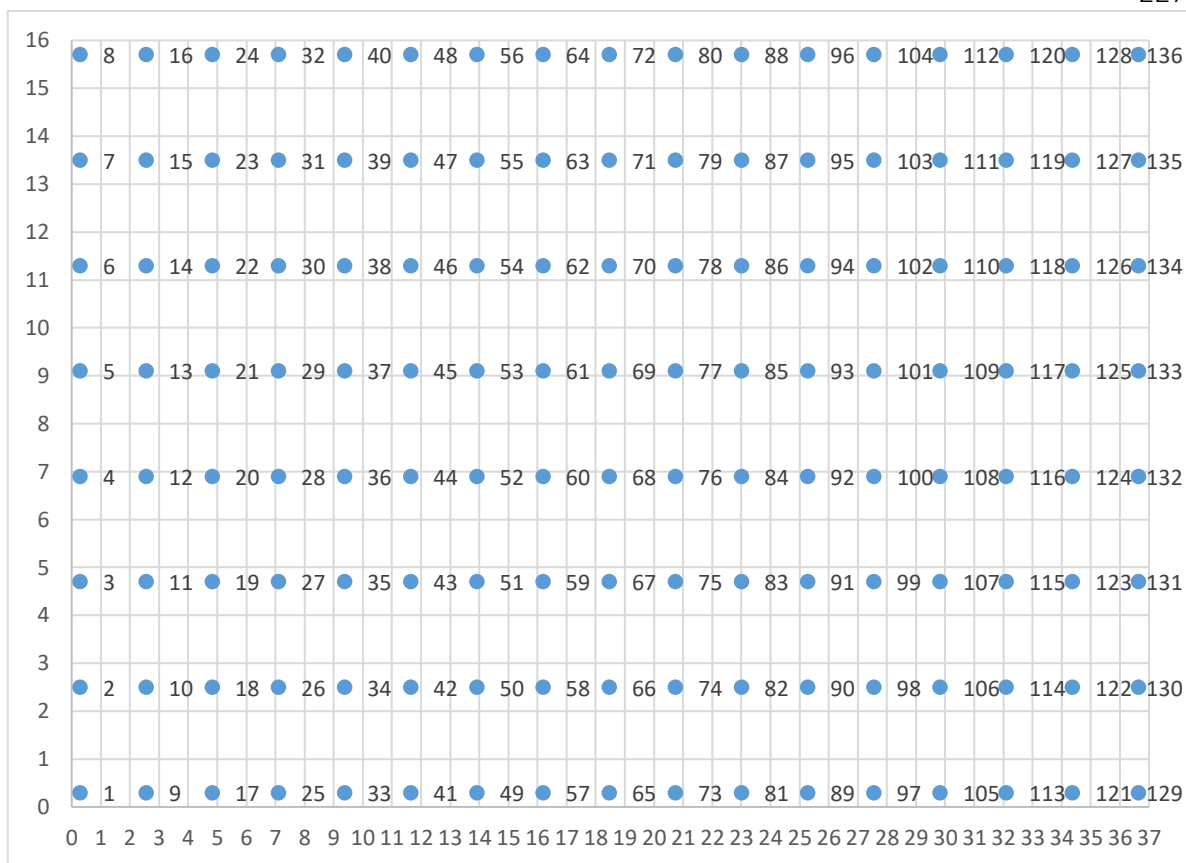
Distribución esquemática en planta de los 136 pilotes de 600 mm de diámetro.
